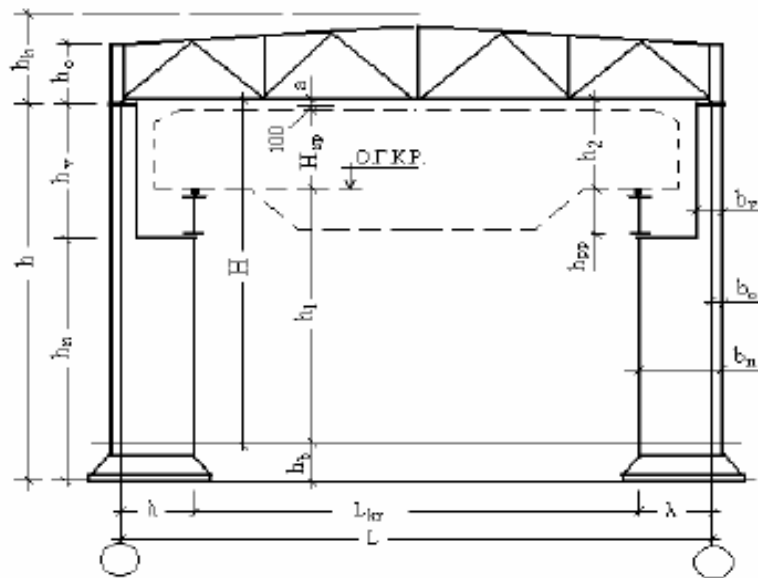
Схема поперечної рами однопрогонової будівлі
